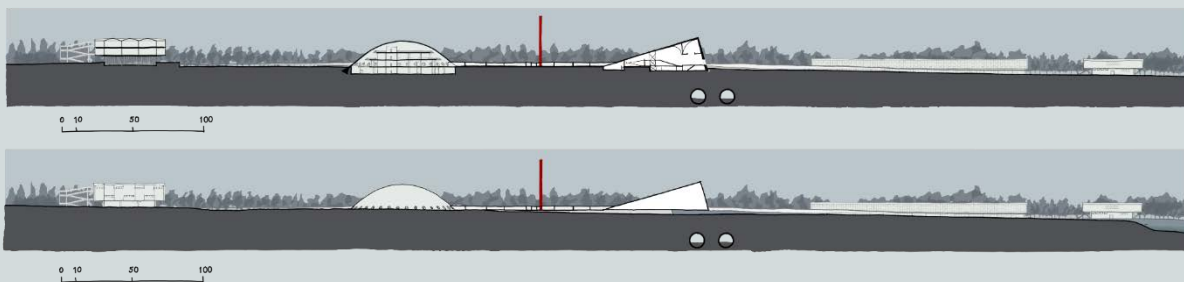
Implantação – 2002 – Versão 03 A – desenho nosso.
